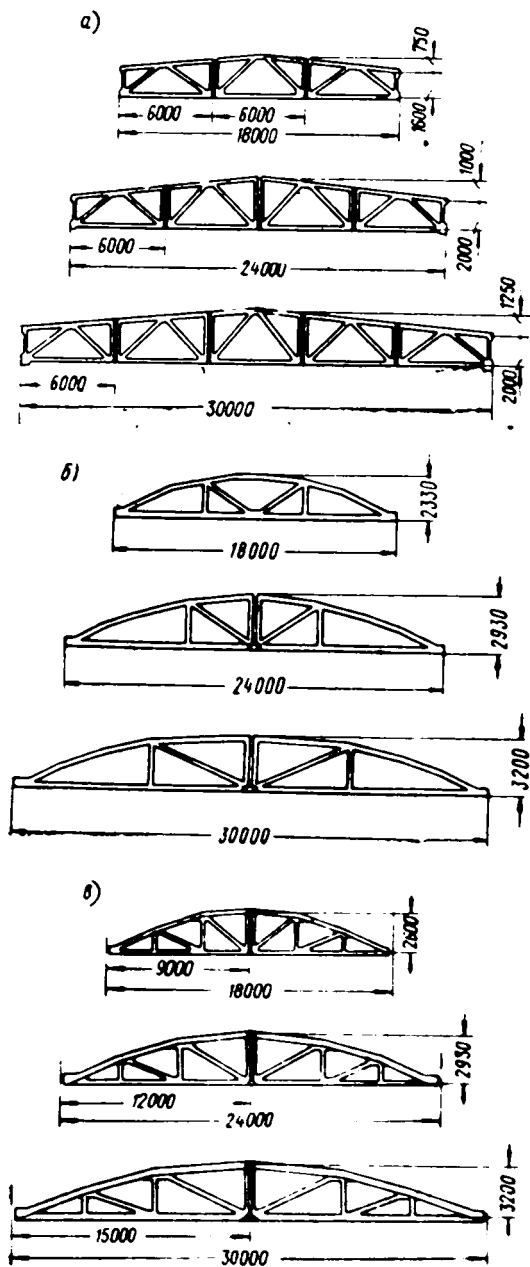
Схемы ферм с натяжением пучковой арматуры на всей длине фермы на бетон (1956 г.)
